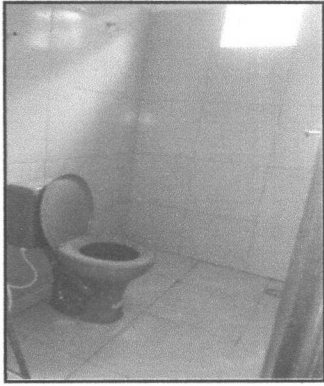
Vista da Banheiro, com destaque ao revestimento cerâmico em paredes e piso
